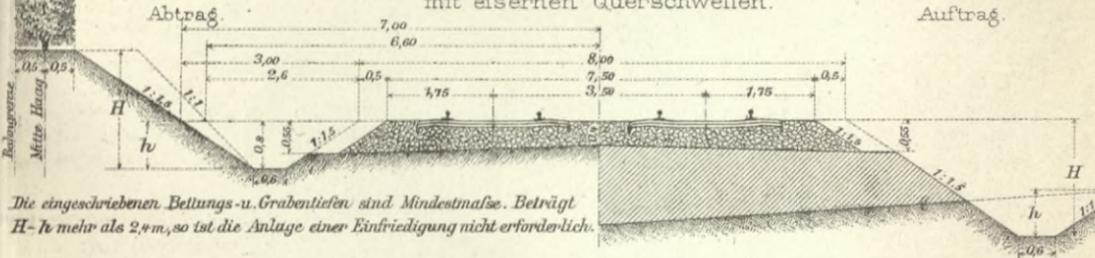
Zweigl. Bahnkörper d. Großh. badischen Staatsbahnen mit eisernen Querschwellen.
